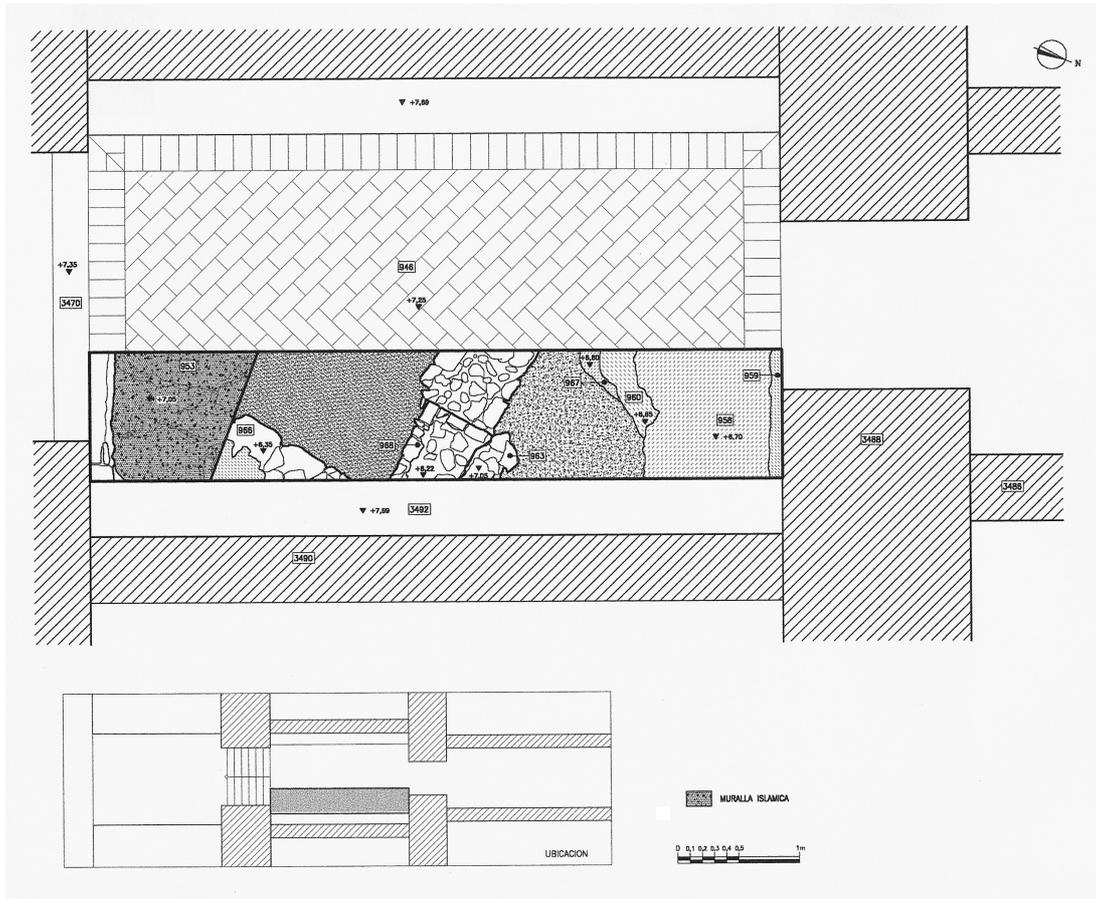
Galería de los Baños. Sondeo SE VII-B. Planta con la zanja de cimentación de la muralla.
